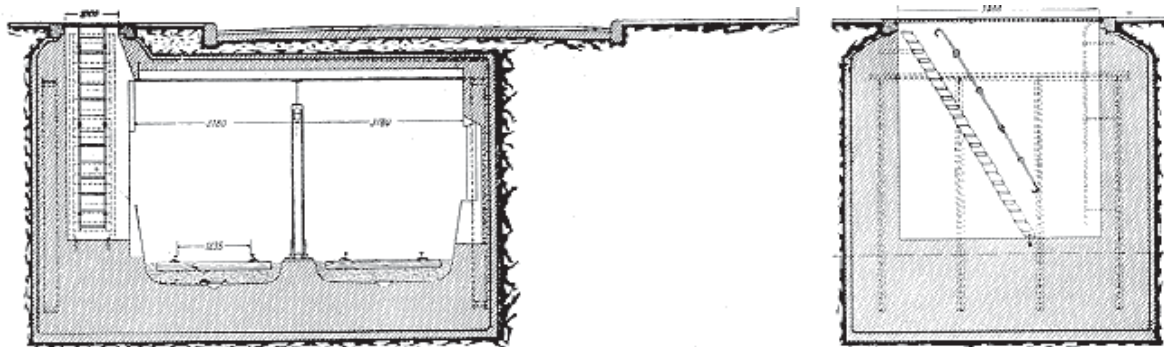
Coupe transversale et longitudinale sur un puits d'aération et sortie de secours.
